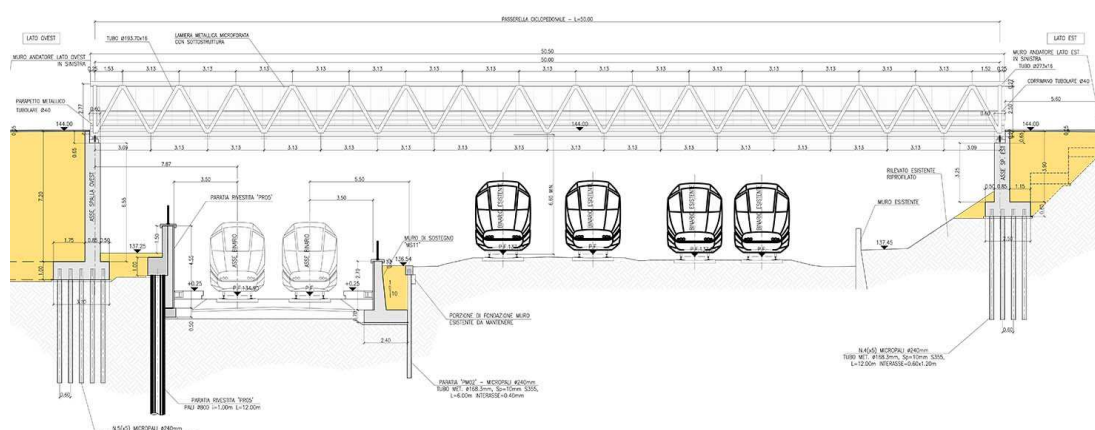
Sezione longitudinale passerella ciclopedonale via Lopez.
